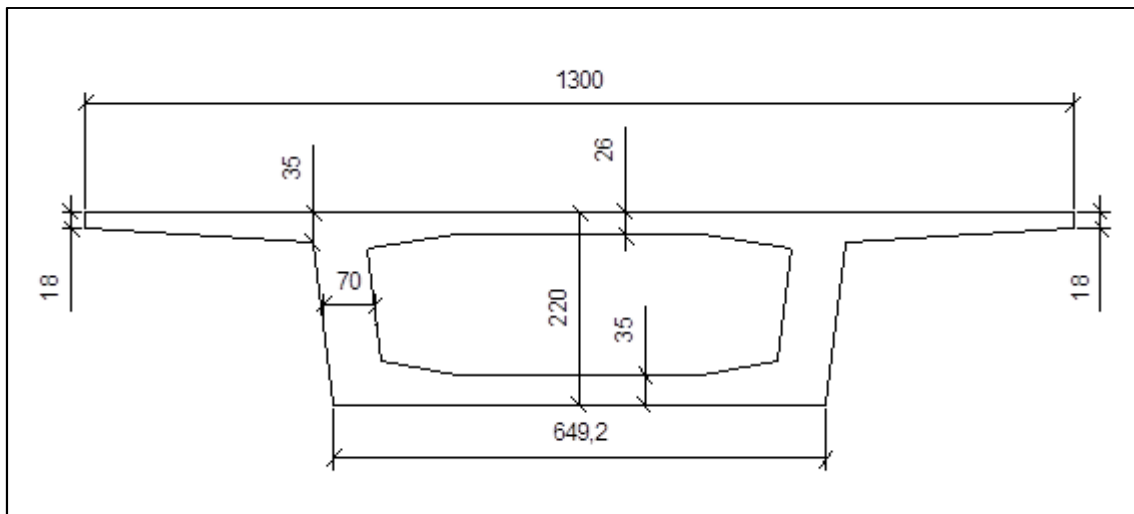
Seção transversal trecho entre pilares – S7 a S9 – (unidades em cm)
